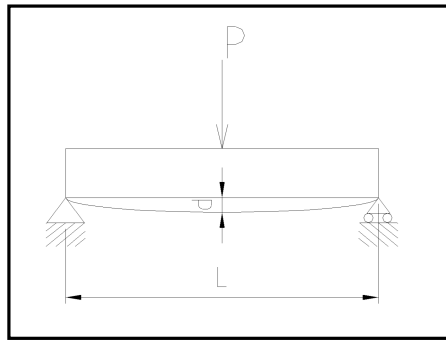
Deflexión de una viga simplemente apoyada con carga central
